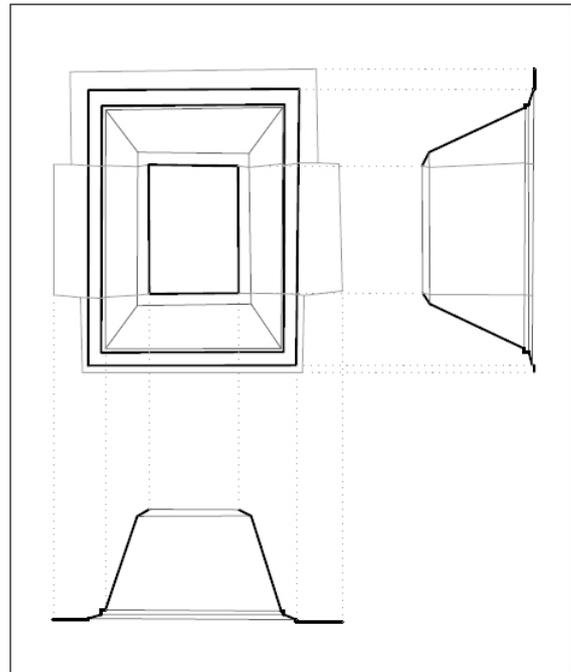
Alzado y secciones del capialzado y su conjunto. Resultado del trabajo realizado por la autora.
